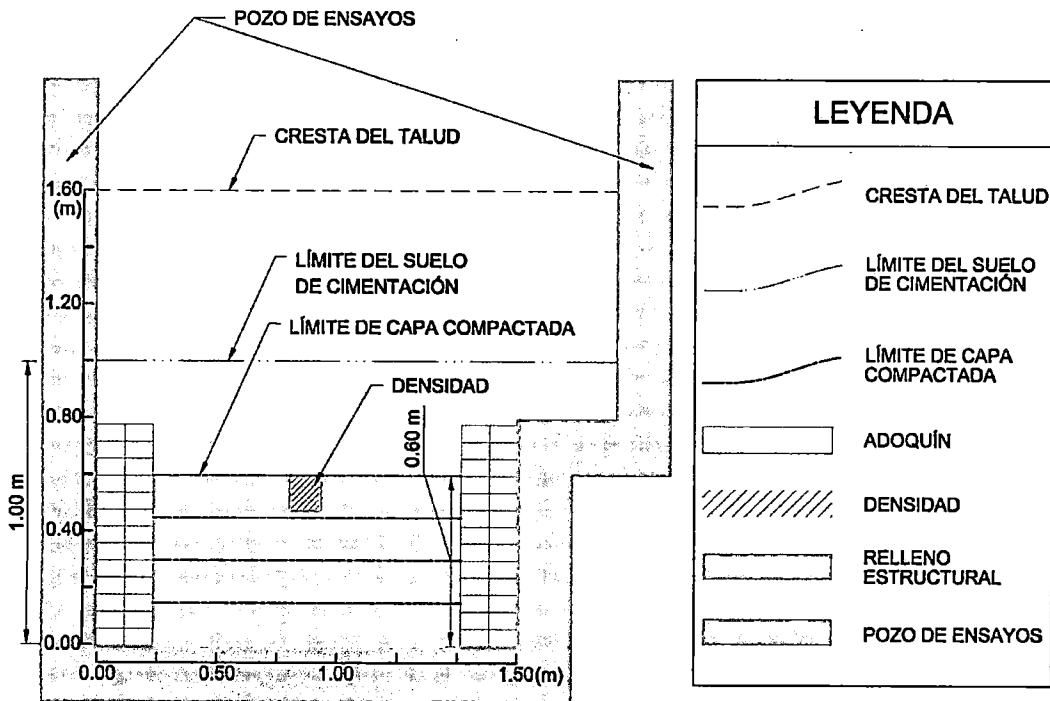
Sección transversal del pozo de ensayos, ensayo SC N°3 - Suelo de cimentación
